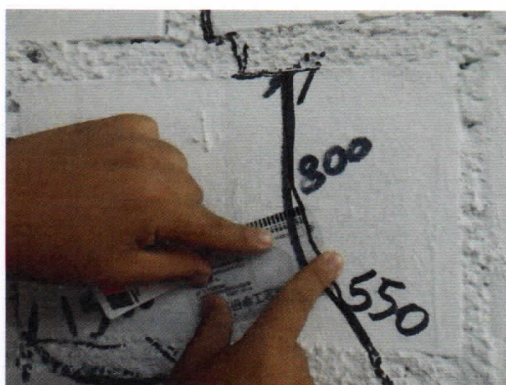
Espesor de grieta de 2.00mm en ladrillo de la cara Sur para una distorsión de 1/400.
